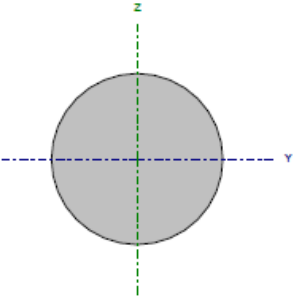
Dimensiones del perfil escogido para las vigas contraviento
